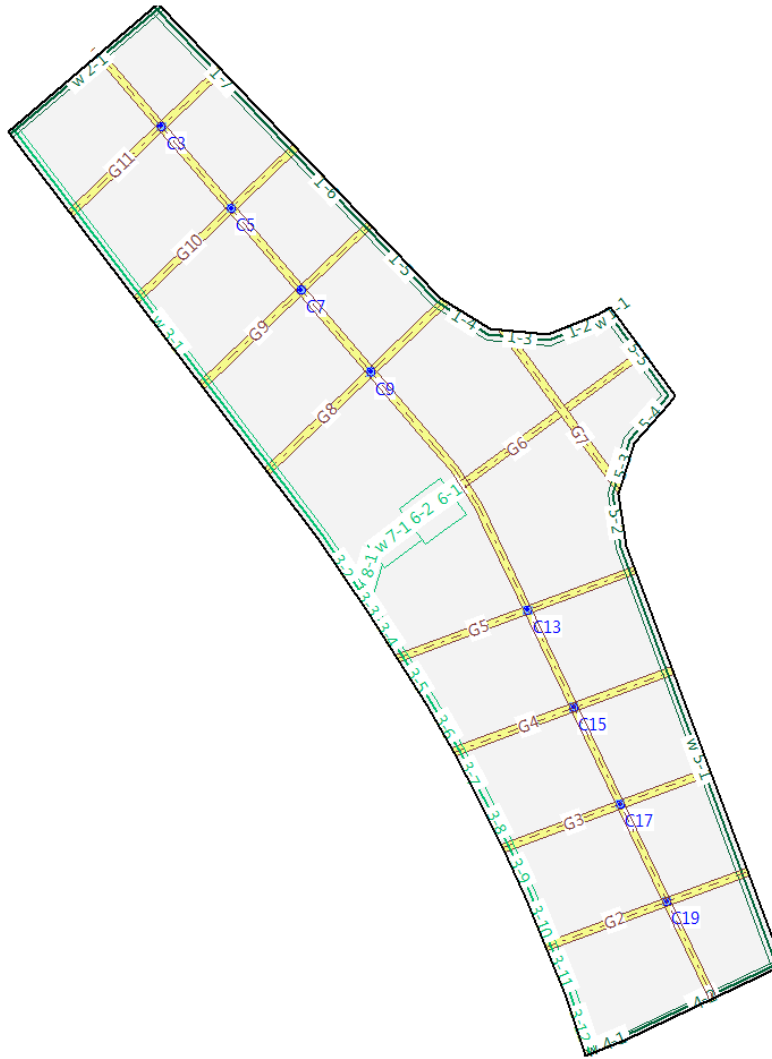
Betonbau Einlaufbauwerk (3D-Modell)
